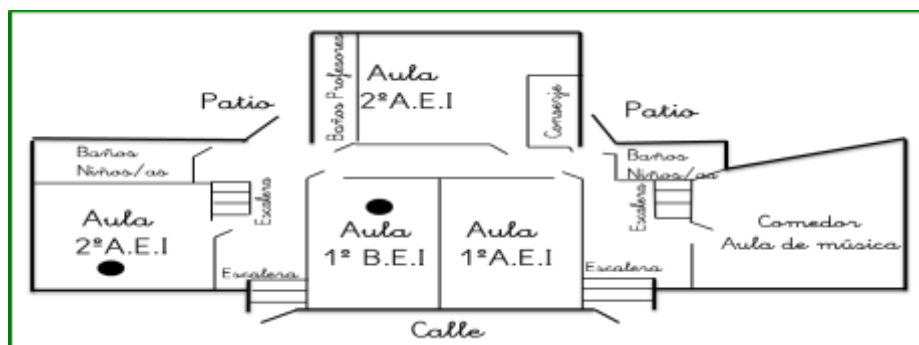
Plano de la planta baja del centro (Elaboración propia)
